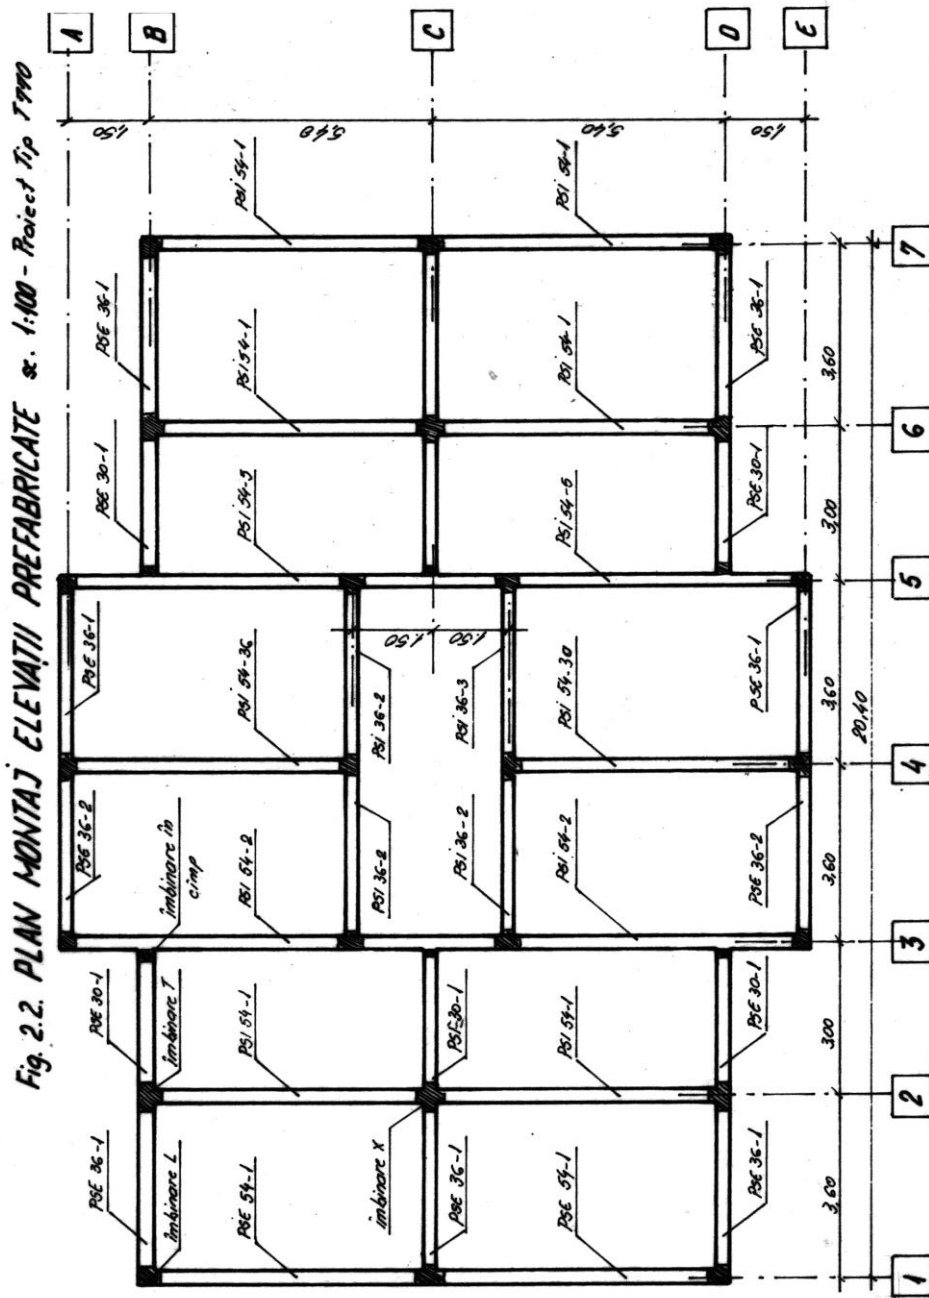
Plan montaj elevații prefabricate. Scara 1:100.
